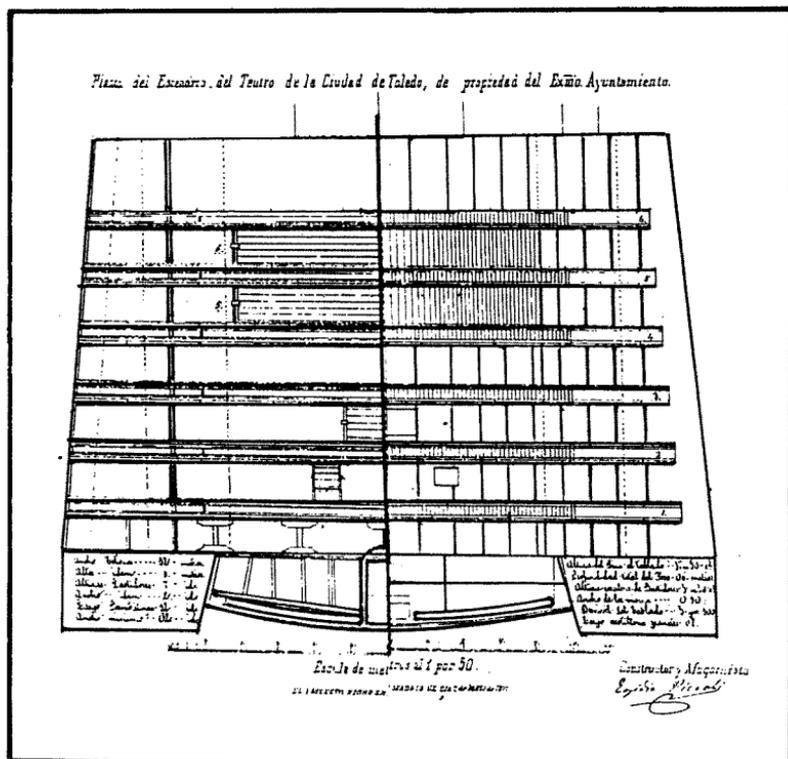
Planta del escenario para disponer los recursos de tramoya. Proyecto de Egidio Picoli, 1876. (A.M.T.).
